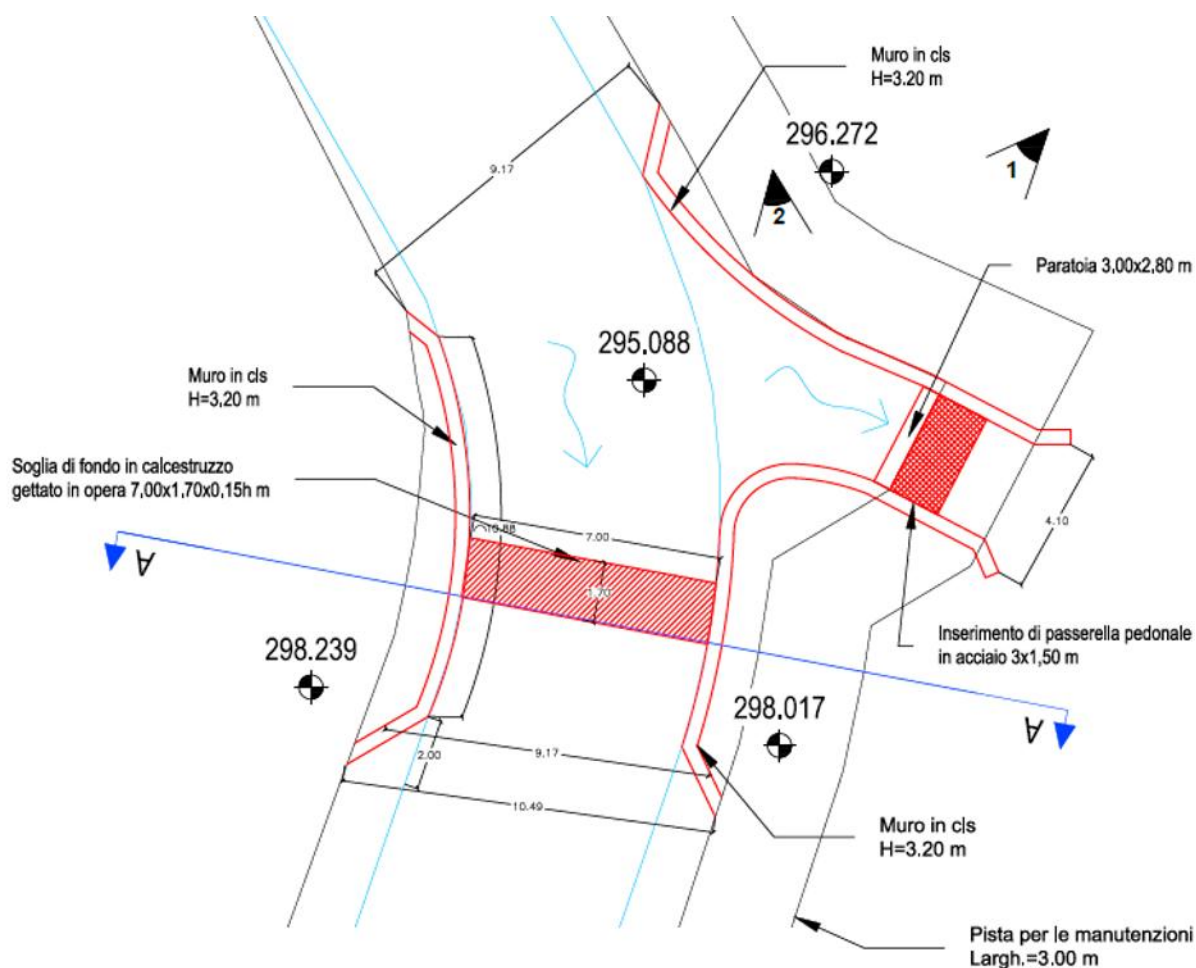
Planimetria di dettaglio del nodo idraulico formato dall'intersezione della Bealera Sturetta ed il canale scolmatore di Cirié.
